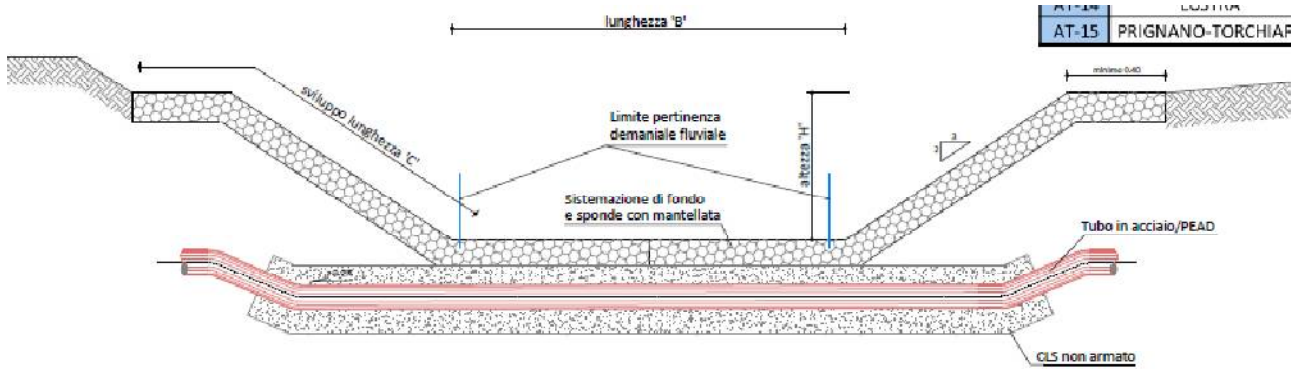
opera tipo attraversamento con protezione spondale in materassi reno
